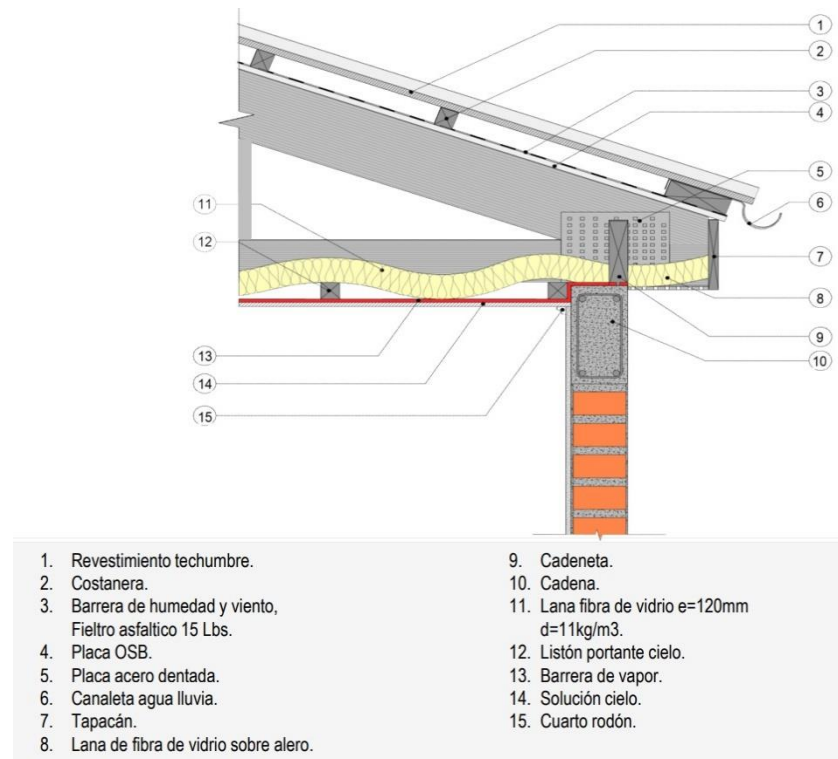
Detalle de solución constructiva para techos Temuco. Fuente [15].
